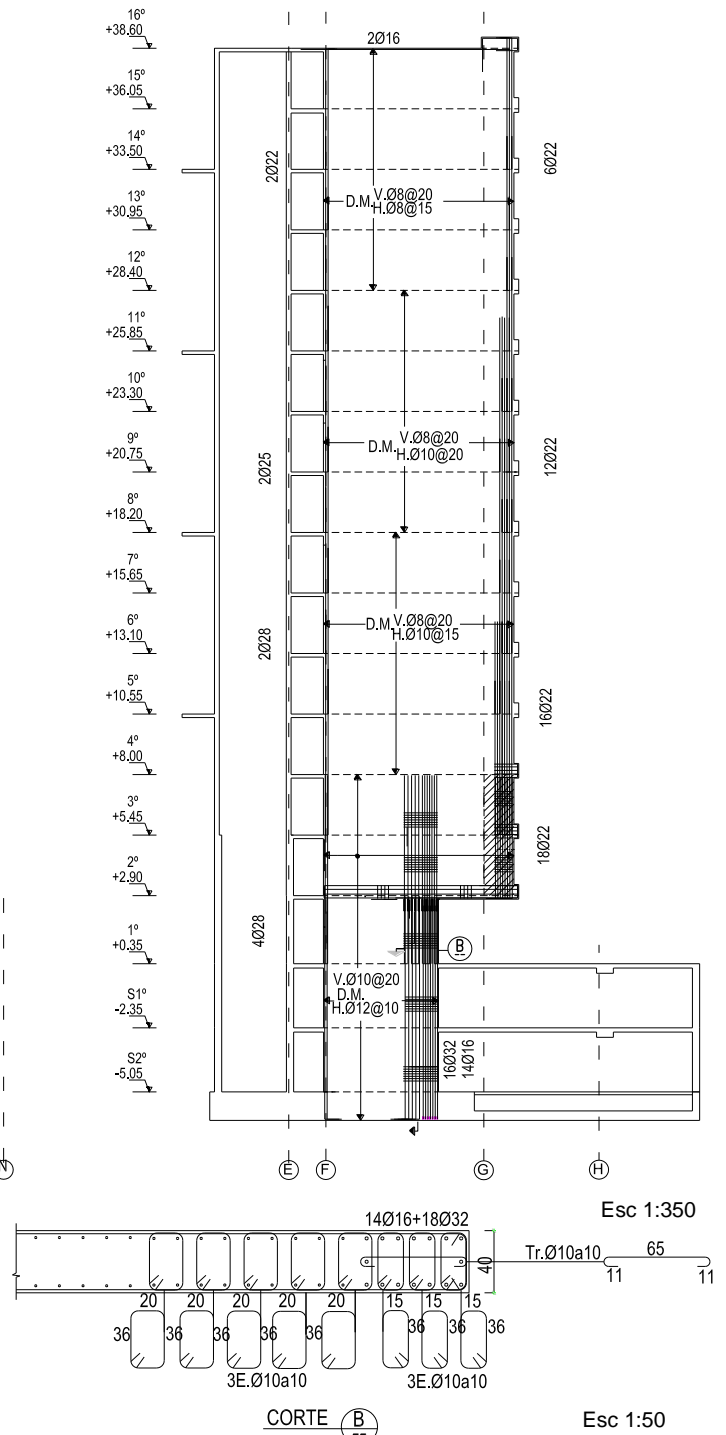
Elevación eje 9 Edificio Boulevard Poniente.
